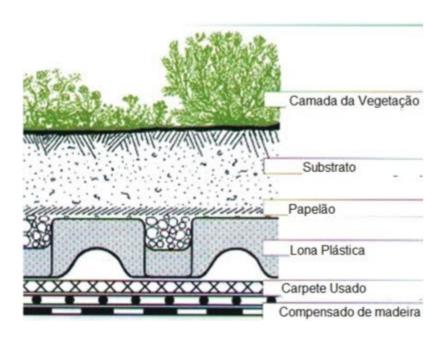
Níveis para montagem do telhado verde. Arkous – Arquitetura e Construção (2011)
